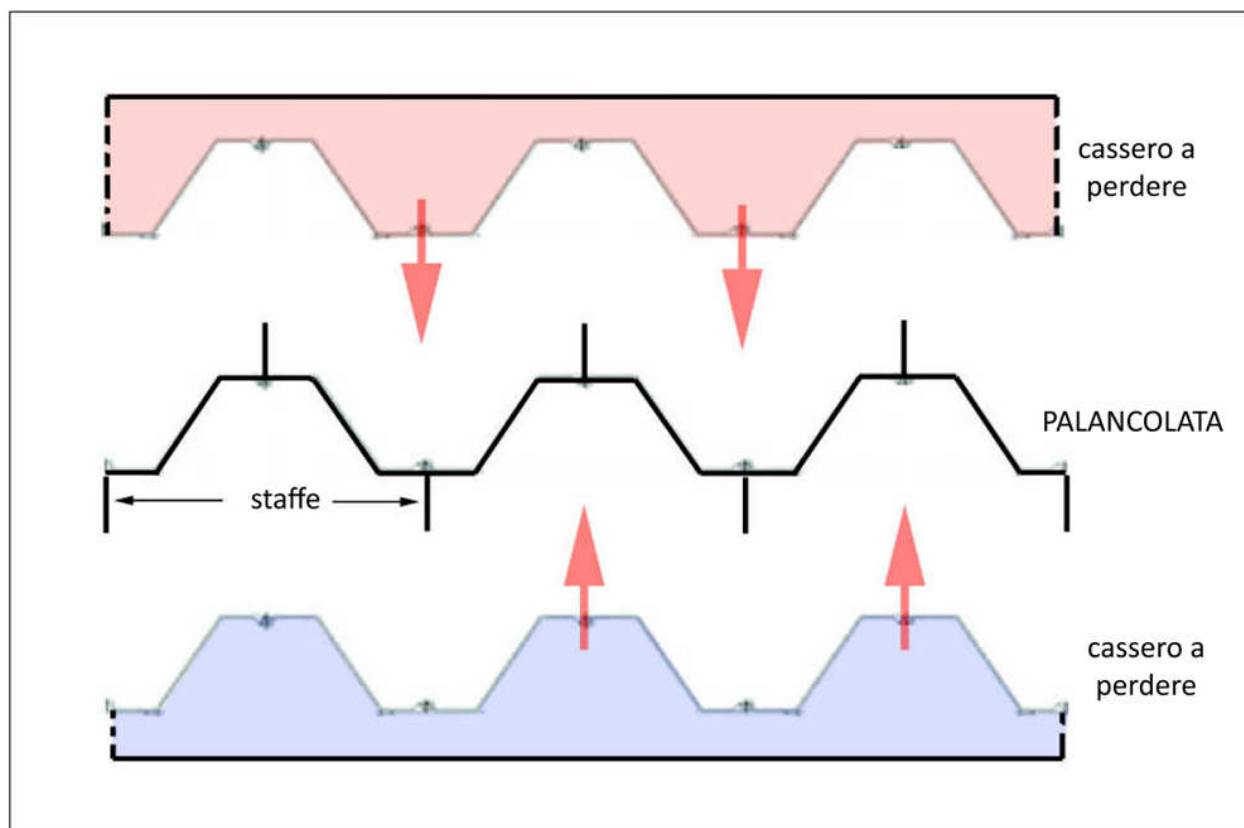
Schema di assemblaggio delle casseforme prefabbricate
